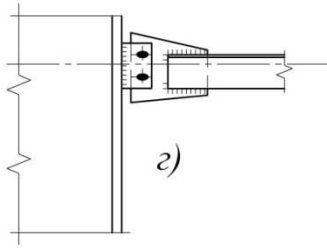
г. Вариант верхнего опорного узла при опирании фермы на колонну или надколонник
